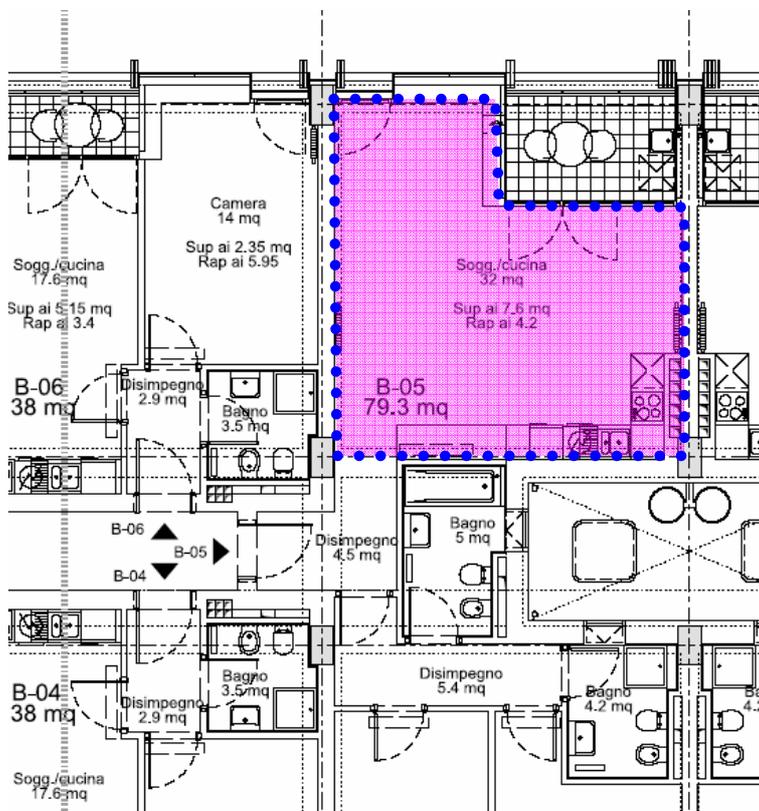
Indicazione della porzione di solaio oggetto di verifica (piano primo)
